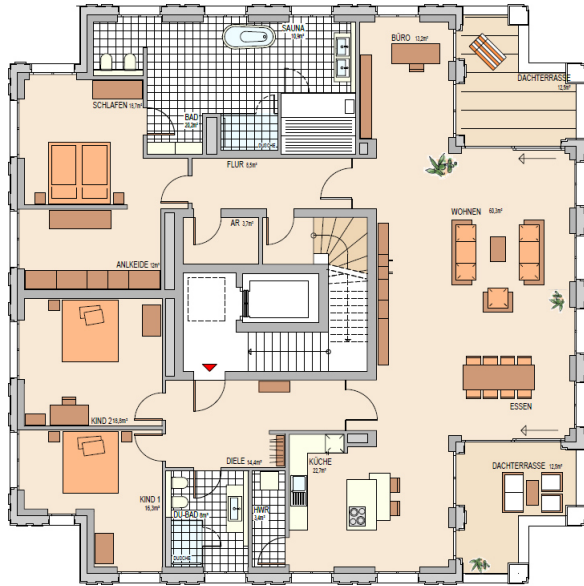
Grundriss Penthousewohnung Wiesbaden
